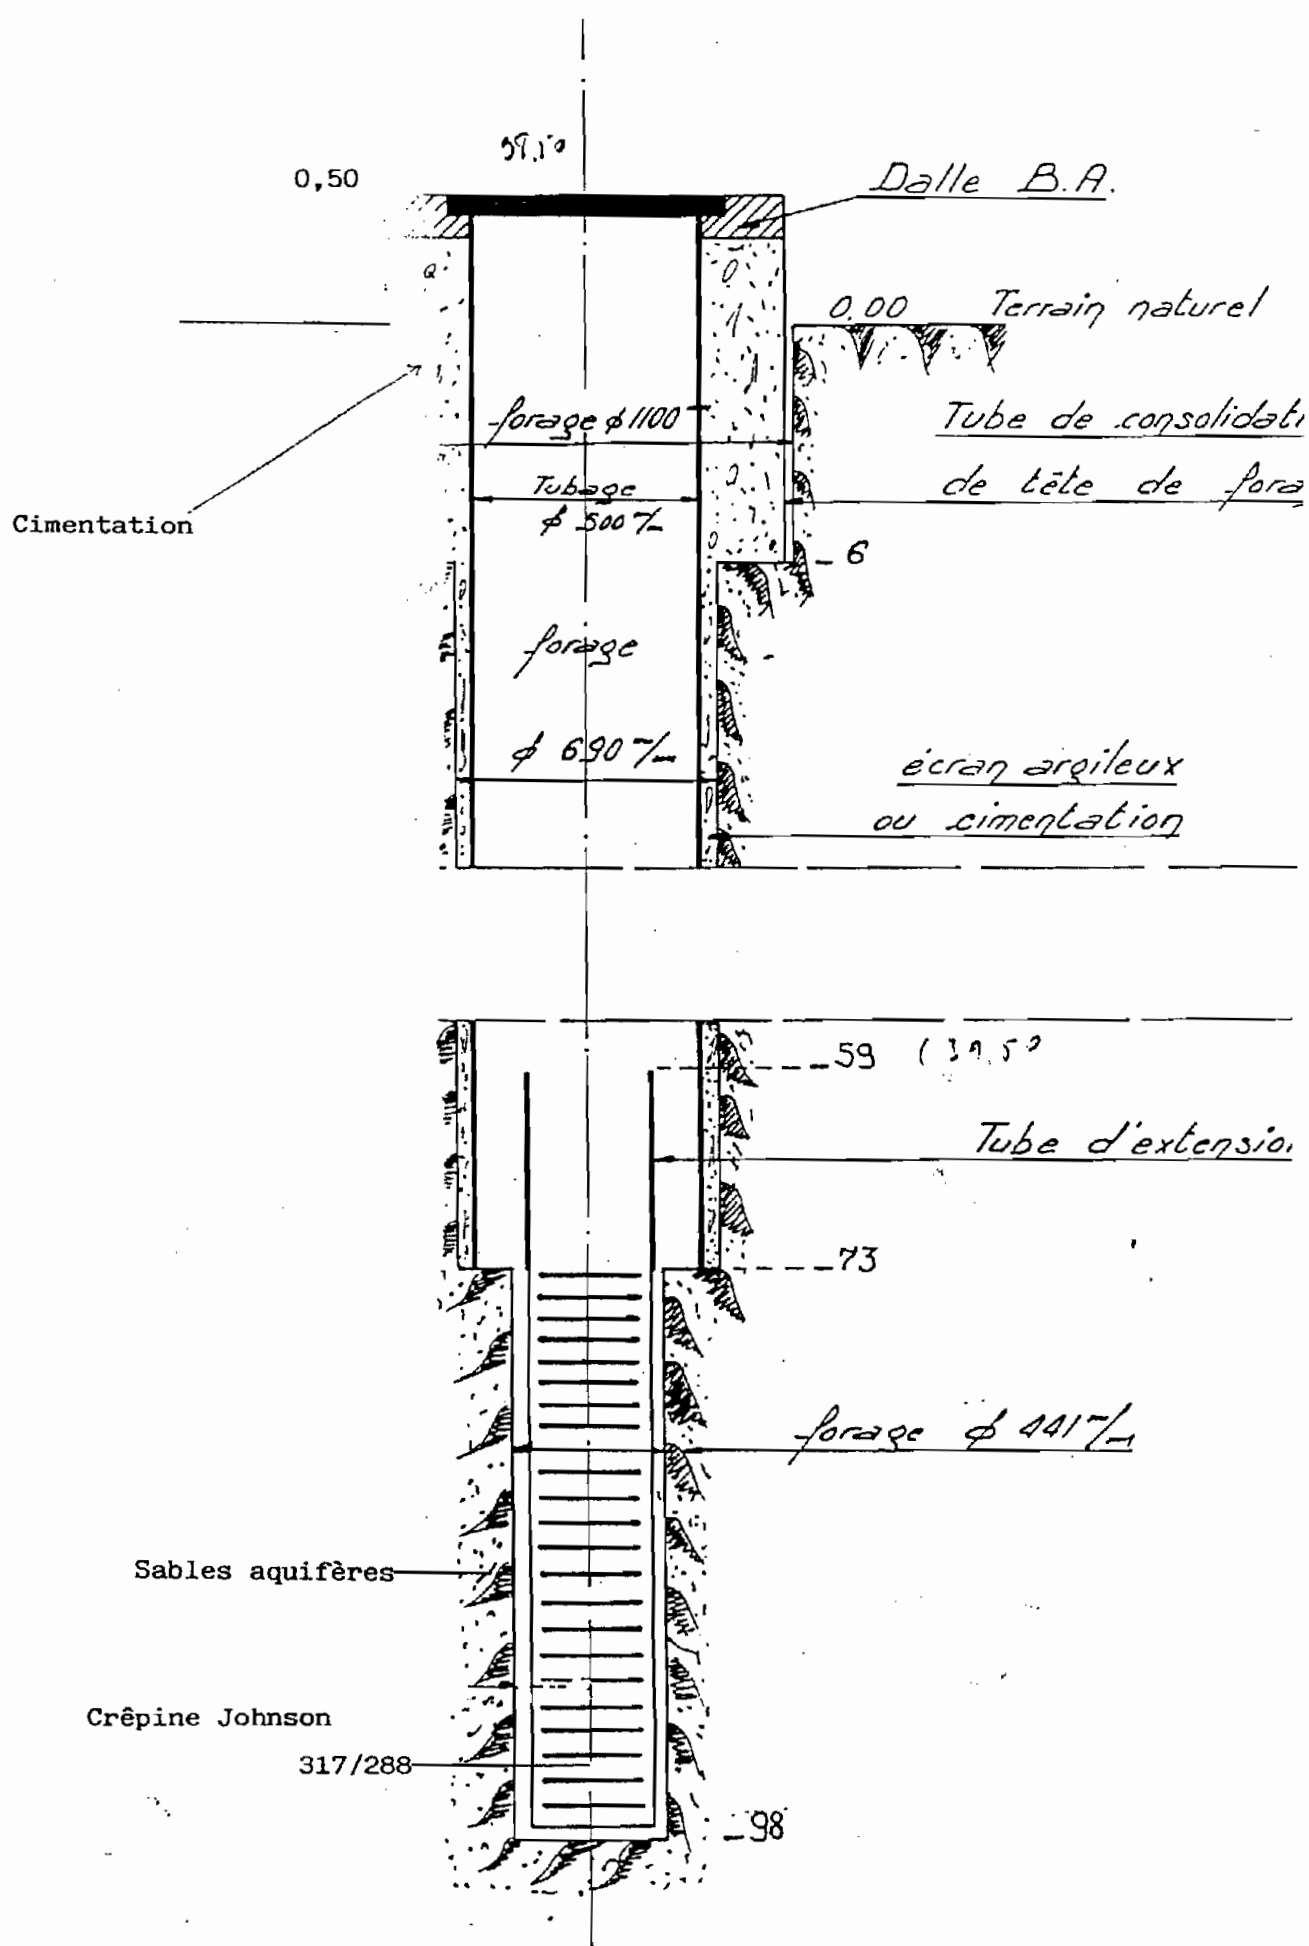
Coupe du Forage de la Route de Brion - Equipements.
